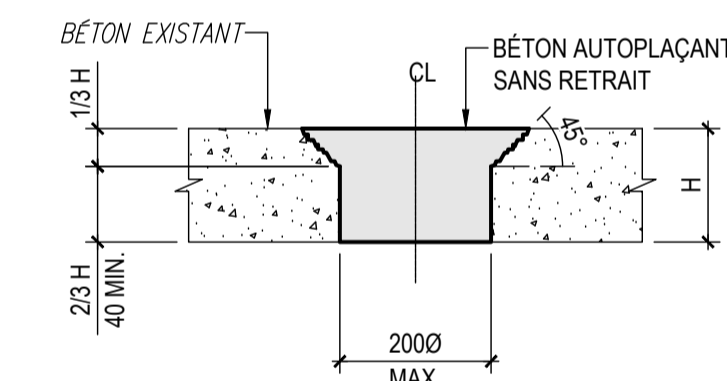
DETAIL TYPIQUE-RAGREAGE DE LA DALLE EXIST. APRES DEMOLITION
